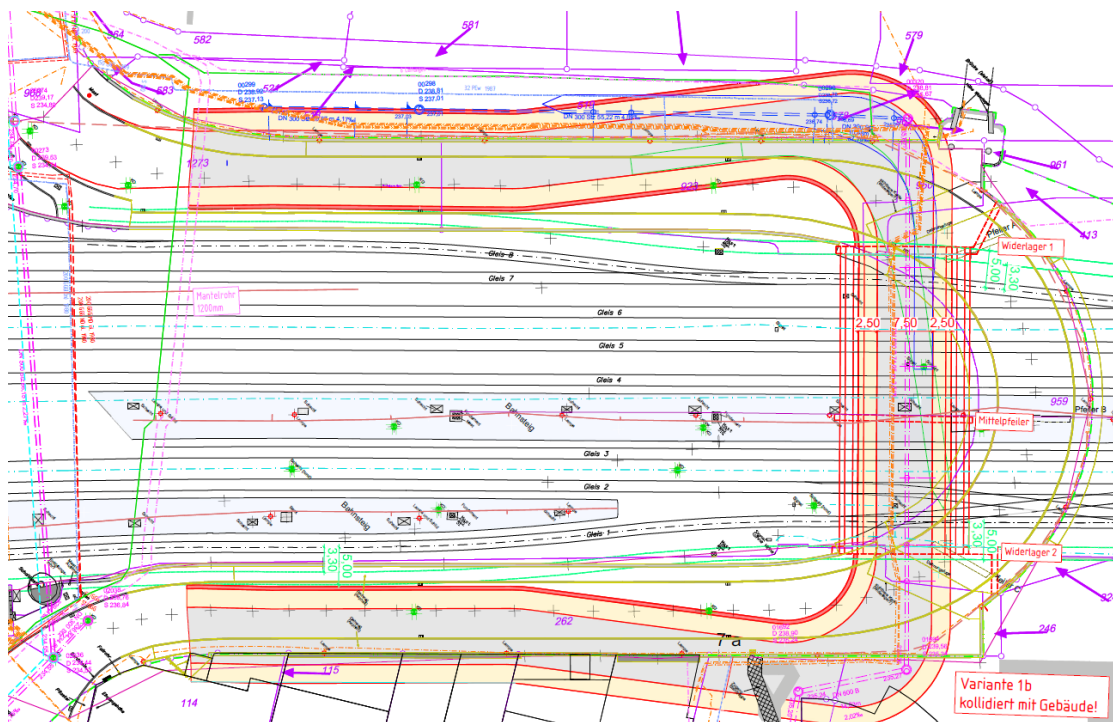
Draufsicht Straßenbrücke gerade Trassierung
